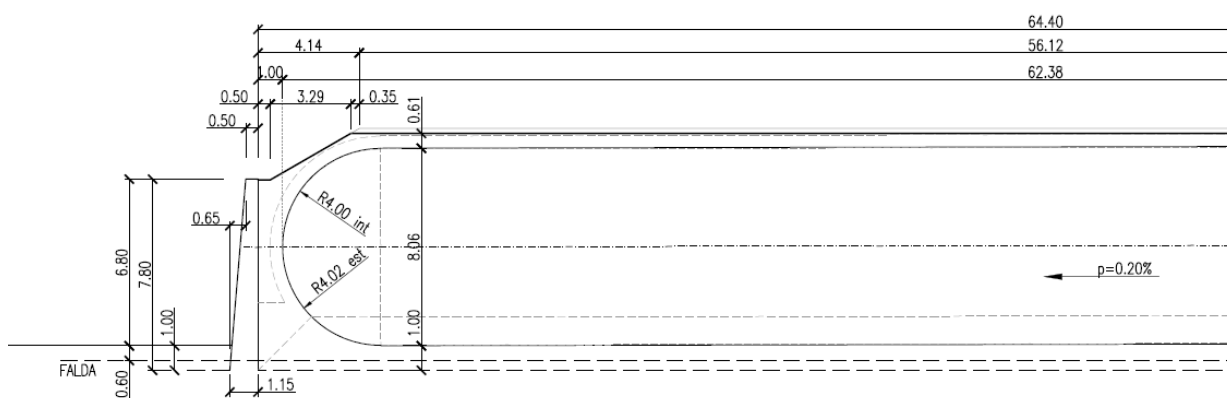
Sezione longitudinale tipo elevazioni.
